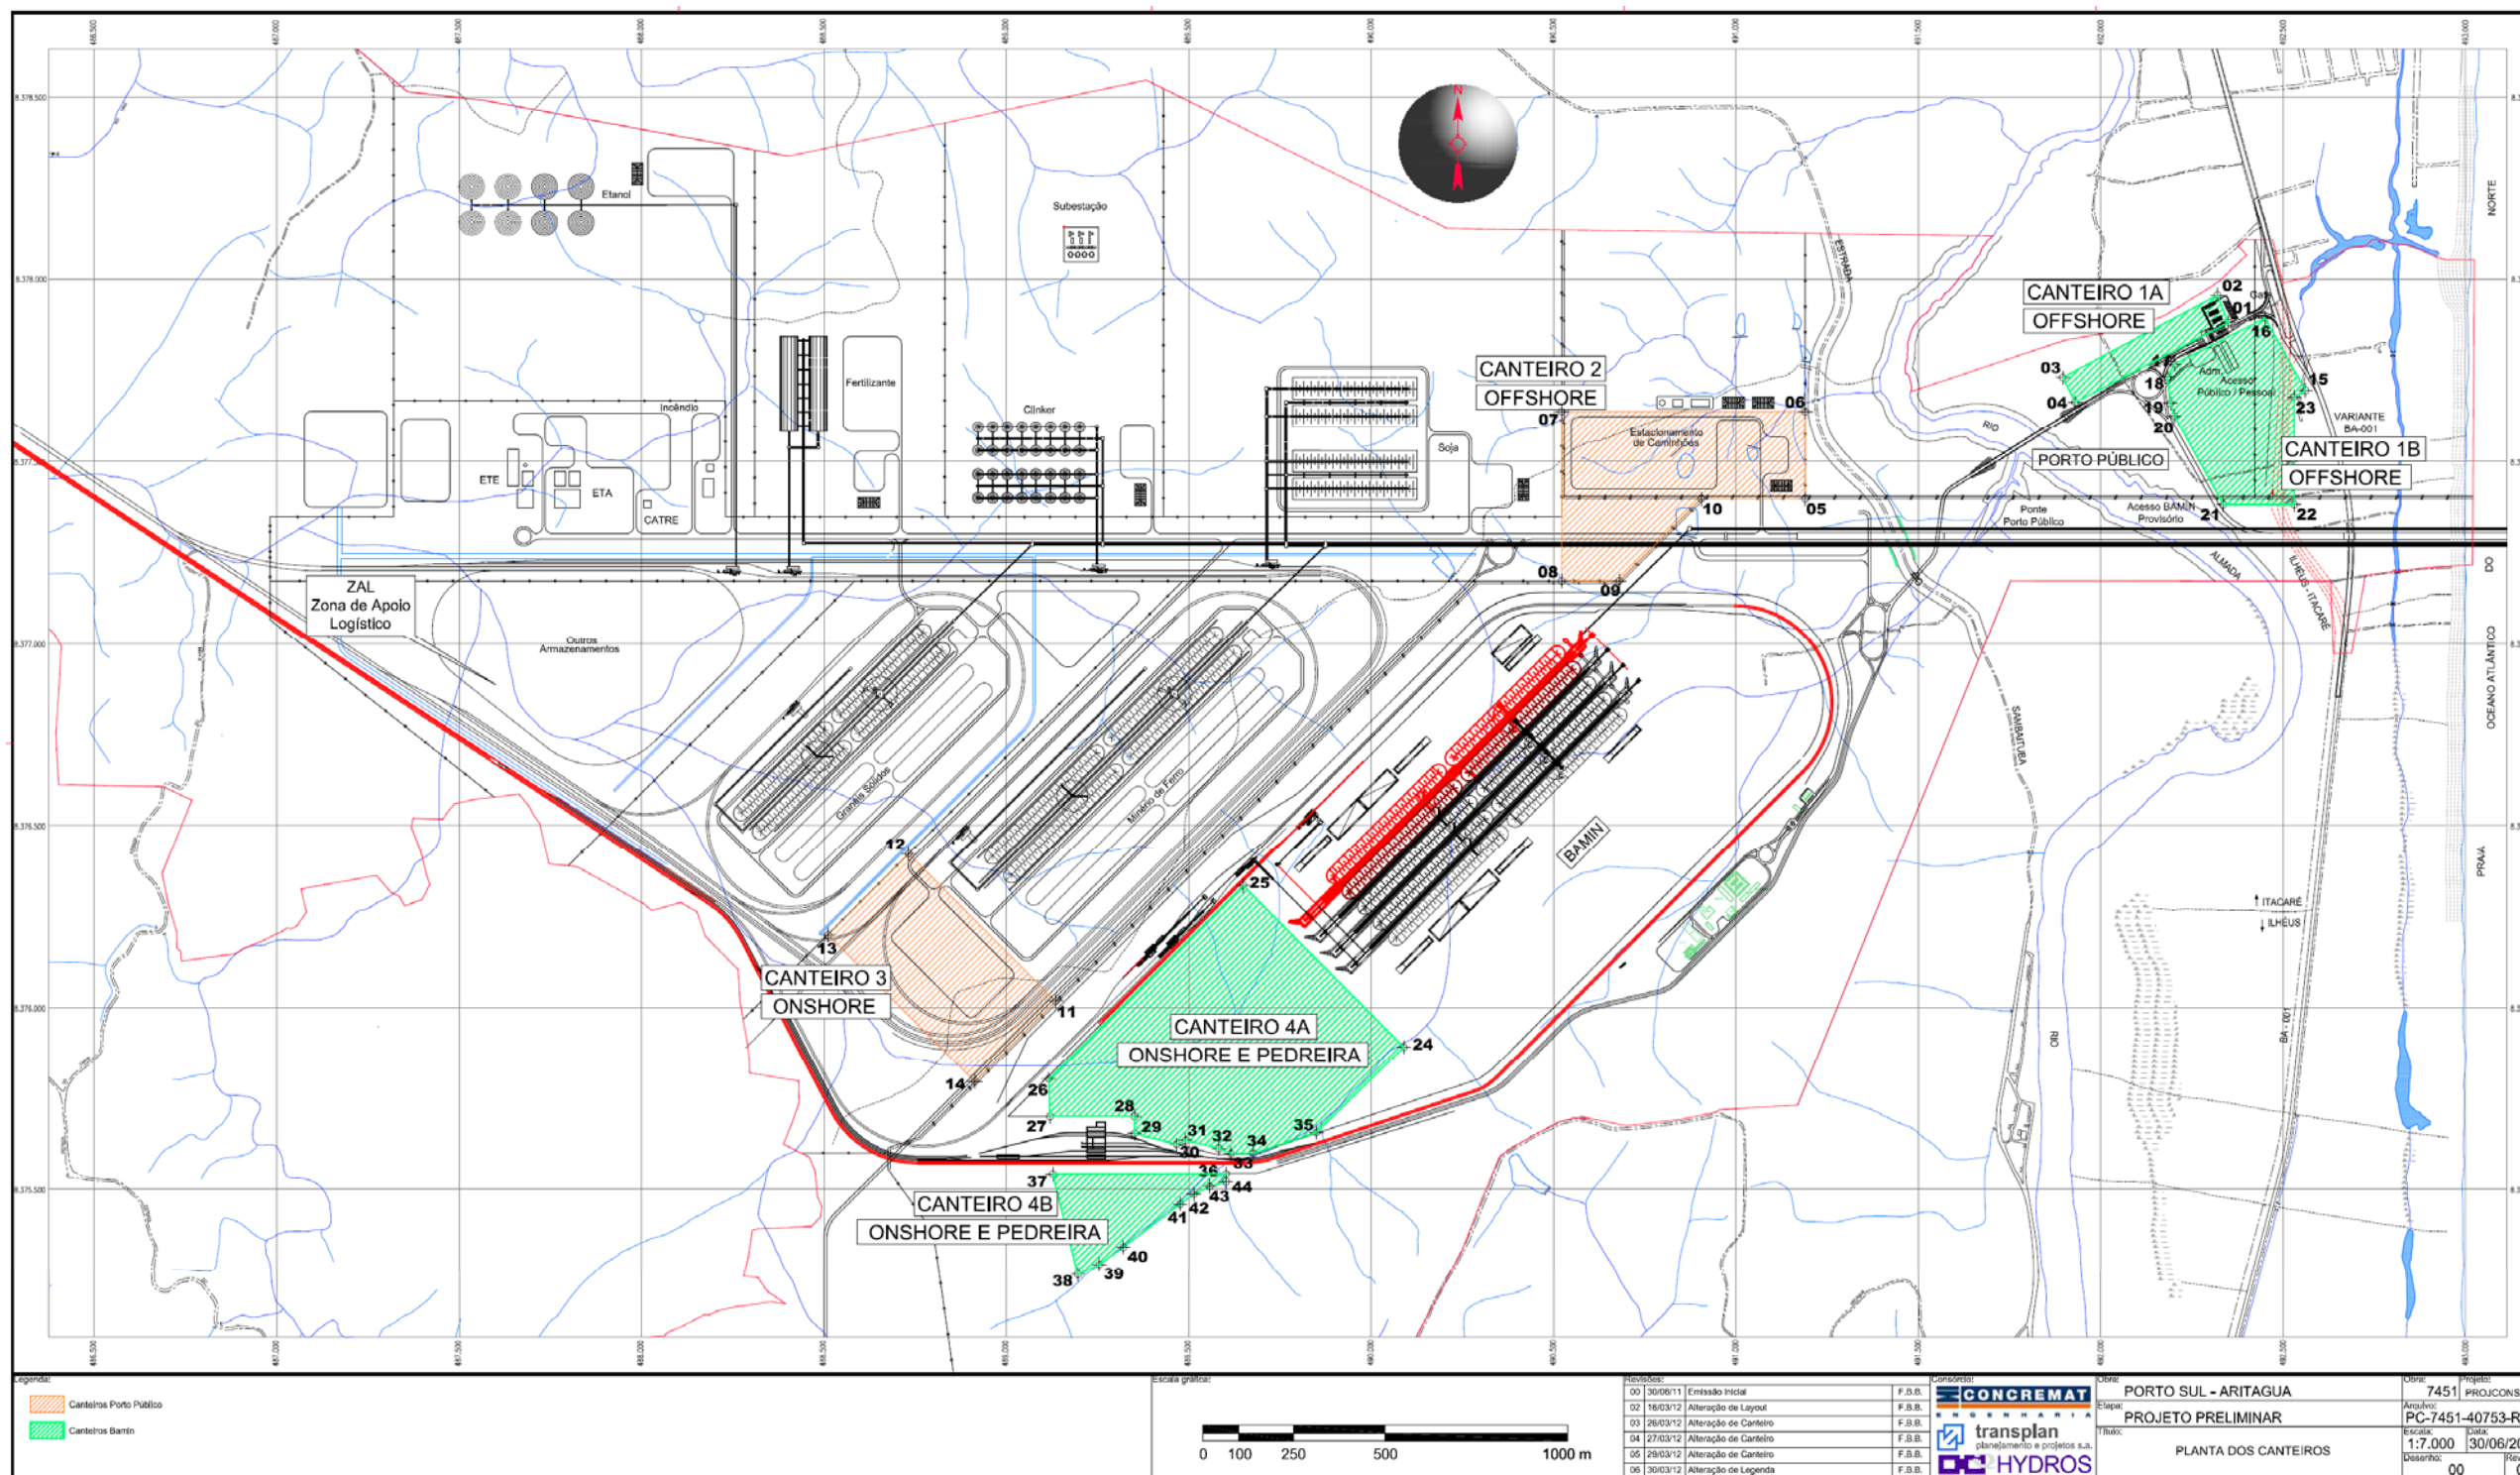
Layout Onshore do Porto Sul, com Detalhamento dos Canteiros de Obras e Acessos.
